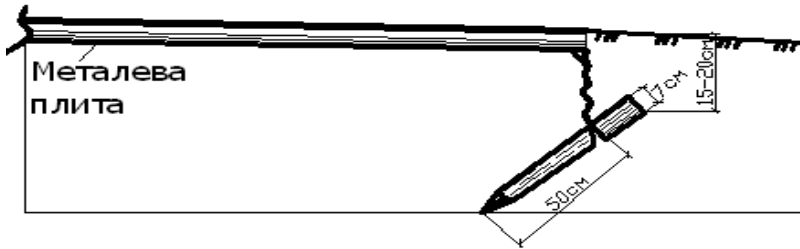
Закріплення країв плит по поздовжнім кромкам покриття
